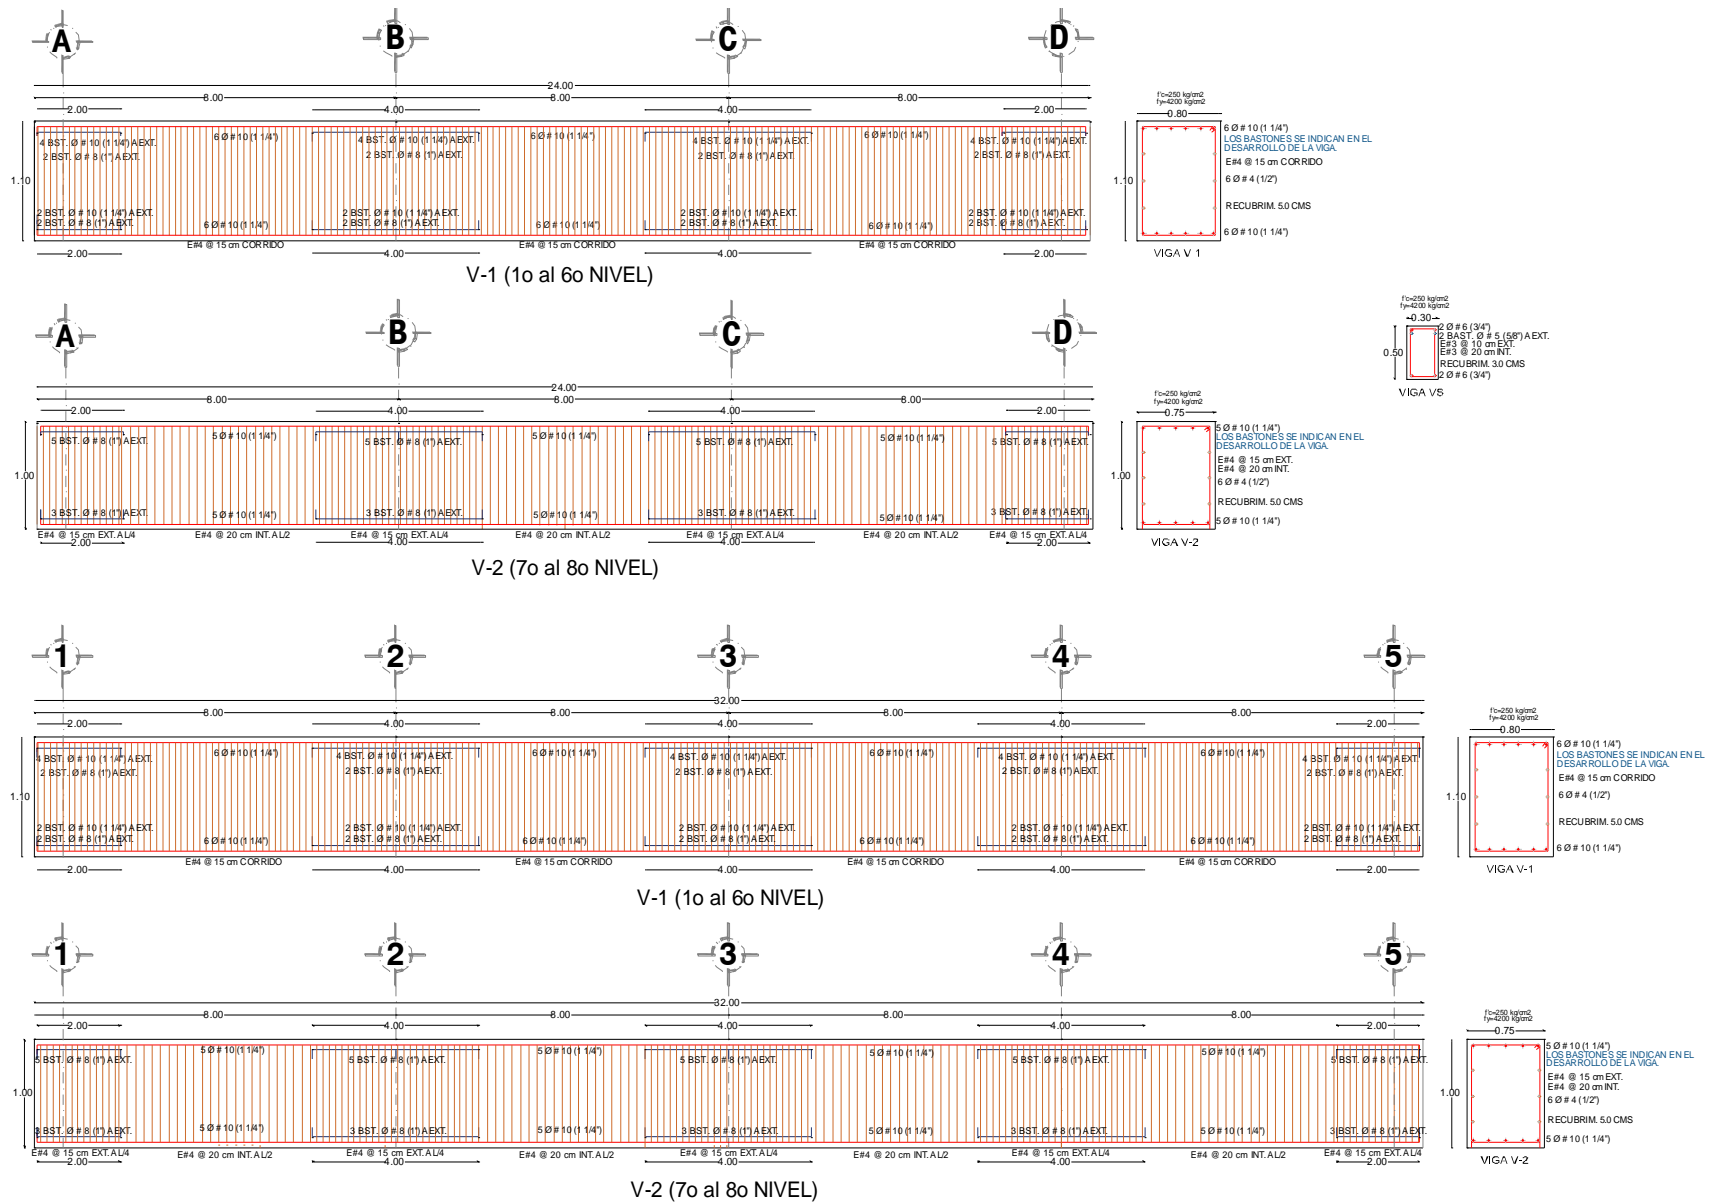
Detallado de armado de vigas de edificio de 12 niveles con base a la hipótesis de las NTCC-04.
